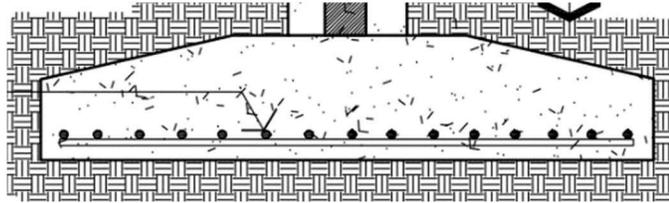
Tipos de zapatas cargadas por defecto en Revit
